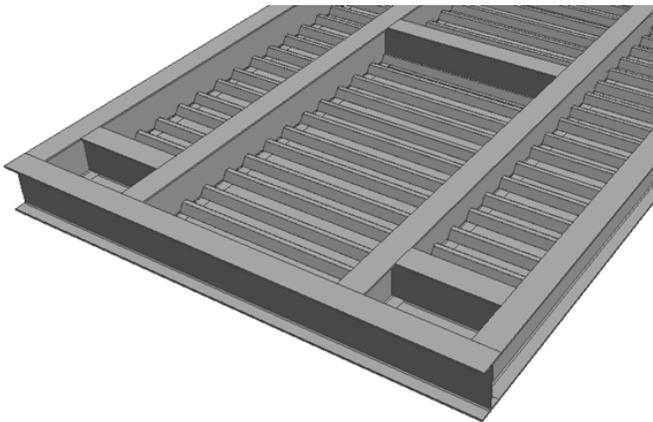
Vista en detalle de placas colaborantes. Modelo de elaboración propia.
